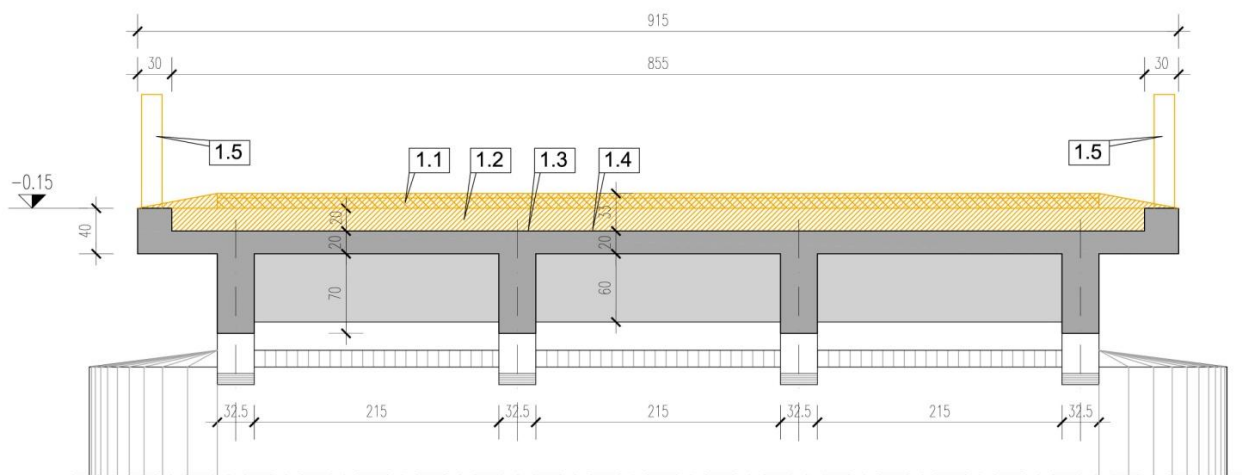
Sezione tipologica impalcato - fase di demolizione
